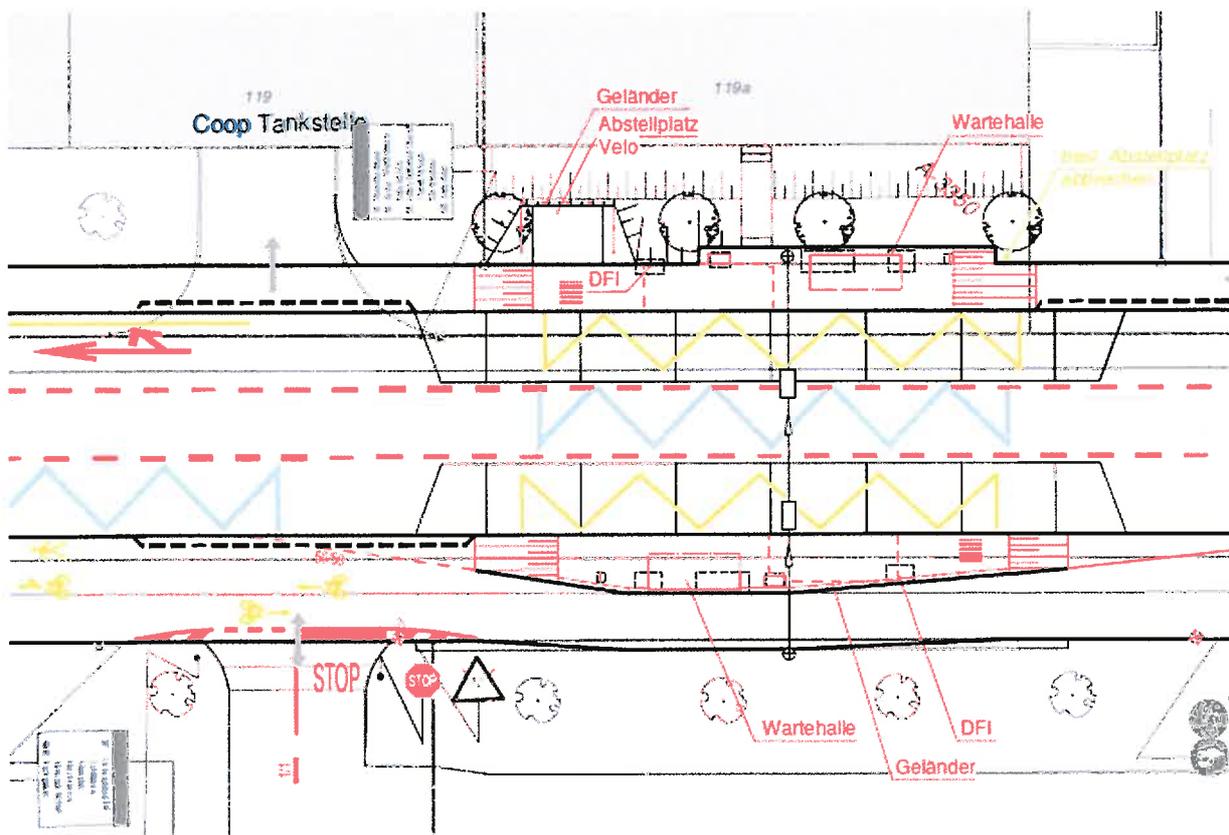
Bushaltestelle „Im Brühl“ mit Darstellung der Haltestellen-Ausrüstung, der Veloführung und der Stop-Markierung bei einer privaten Ausfahrt
